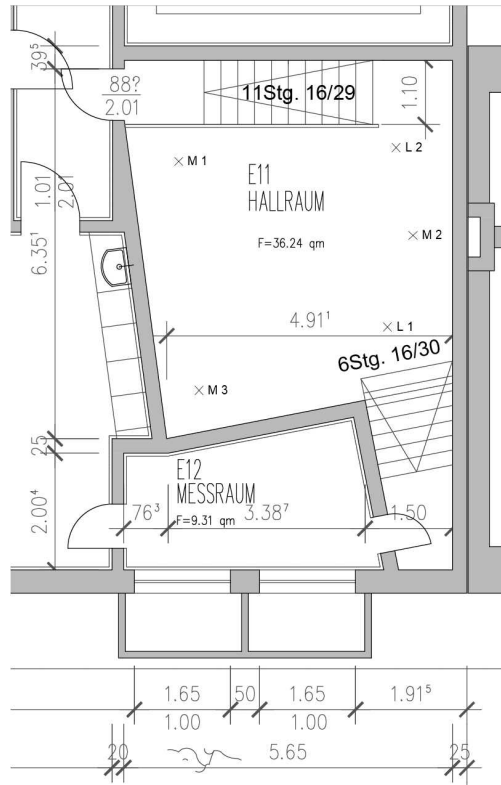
Grundriss des Hallraumes (Ohne Maßstab)
